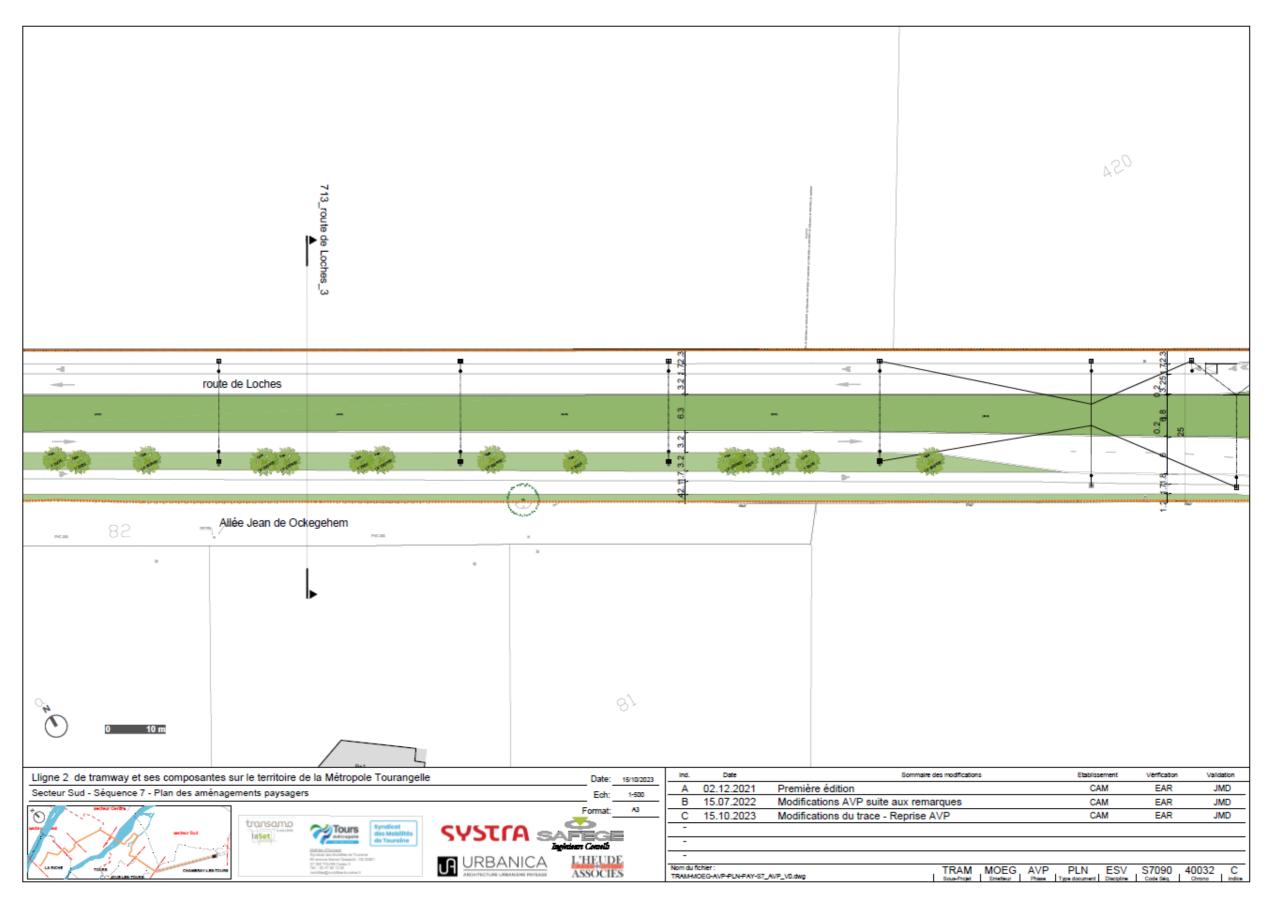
plan masse de localisation des arbres à abattre sur route de Loches (planche 18)
